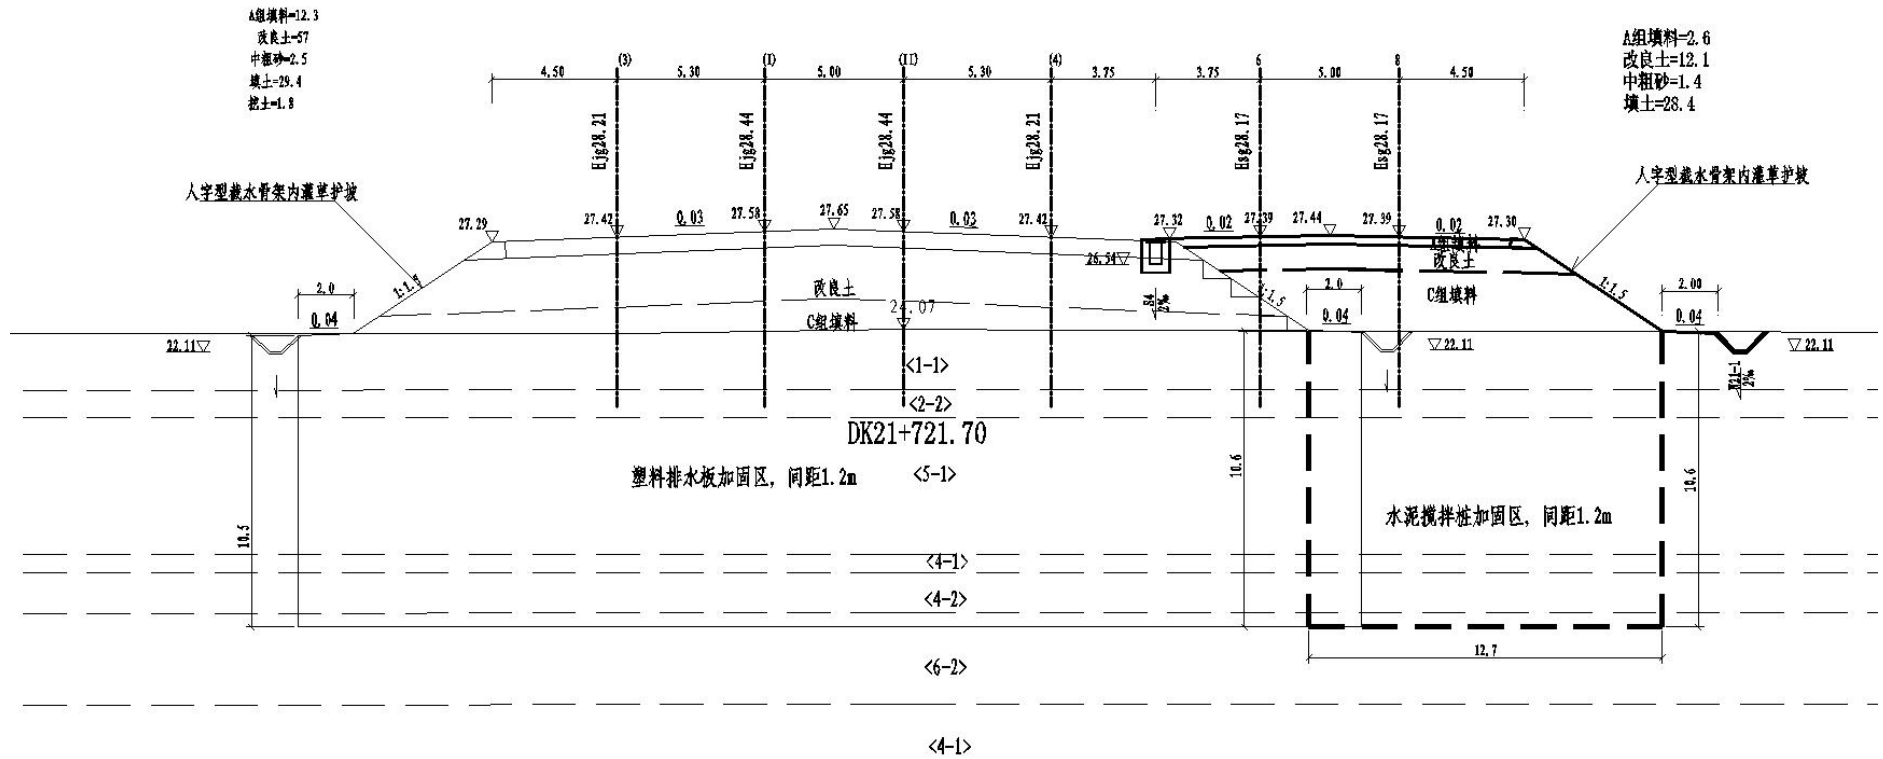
林四房站改造水泥搅拌桩处理代表性横断面图
